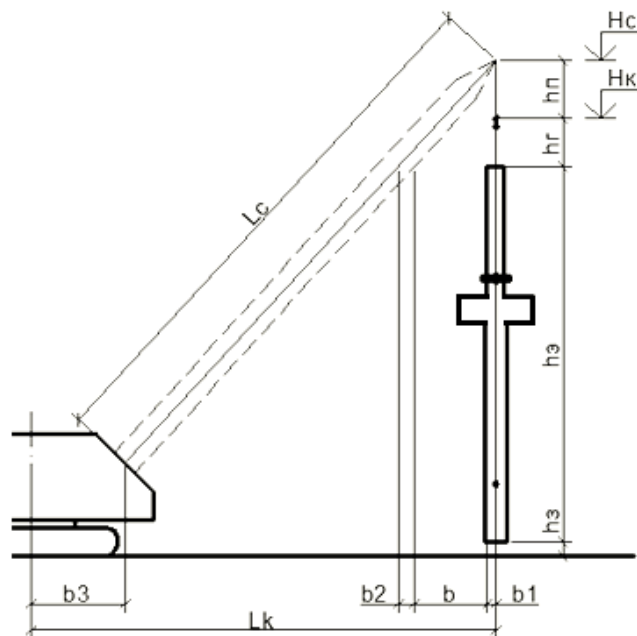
Схема к подбору крана для возведения колонн
